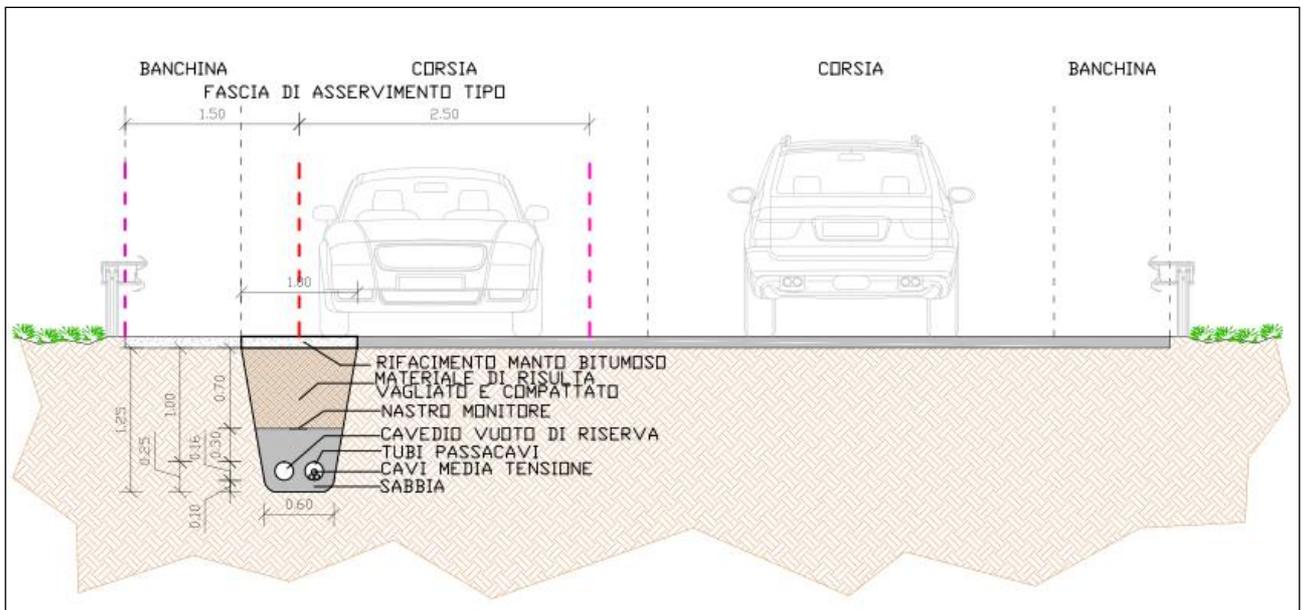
Sezione tipo di attraversamento interrato su strada asfaltata.
